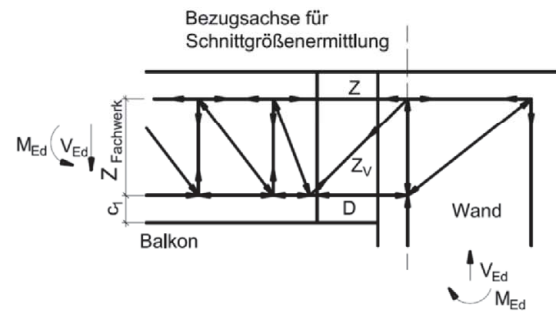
Schöck Isokorb® Typ K-O und K-O-F mit Anschluss an Wand
